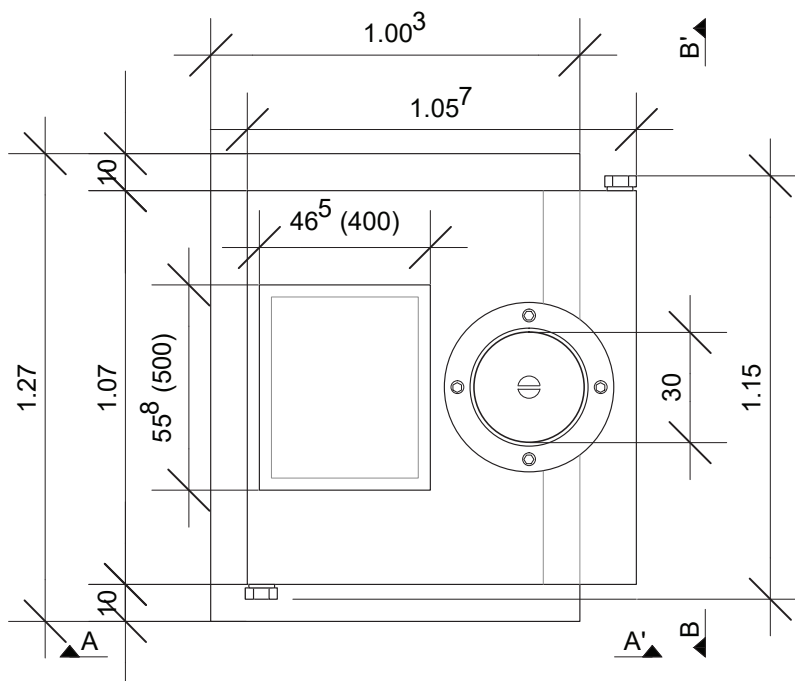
Abfallsammelbehälter, Grundriss
